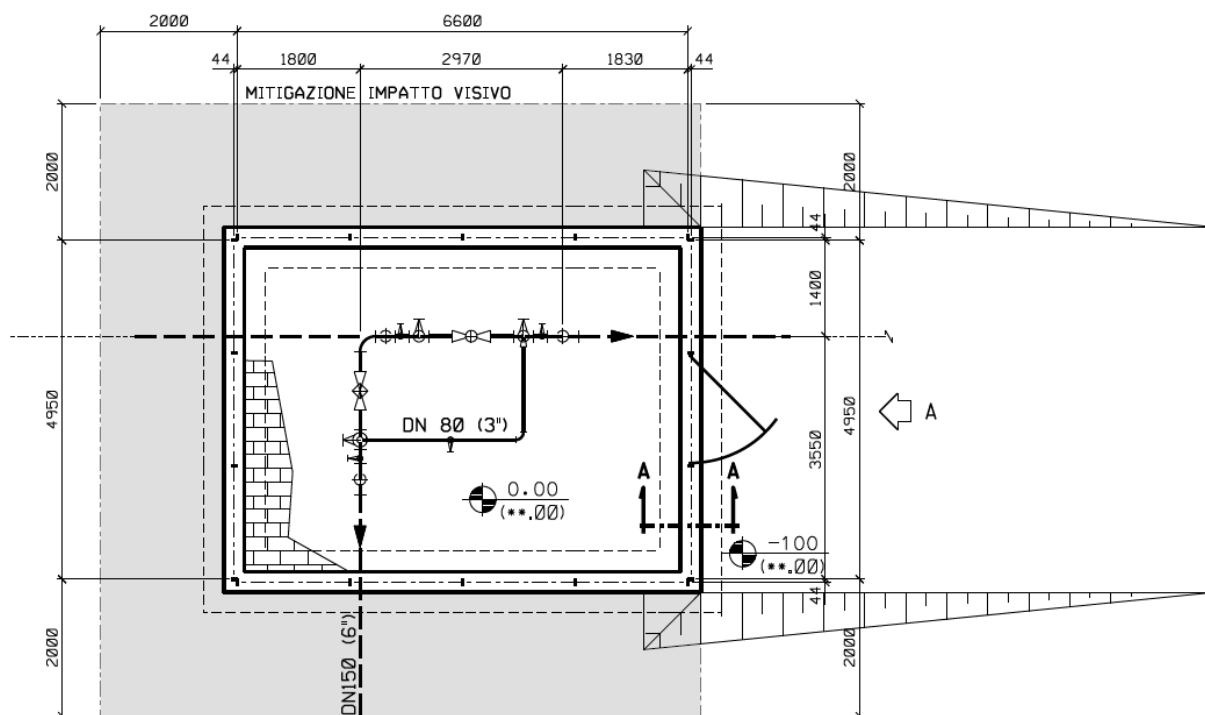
Inquadramento planimetrico delle opere in progetto.
